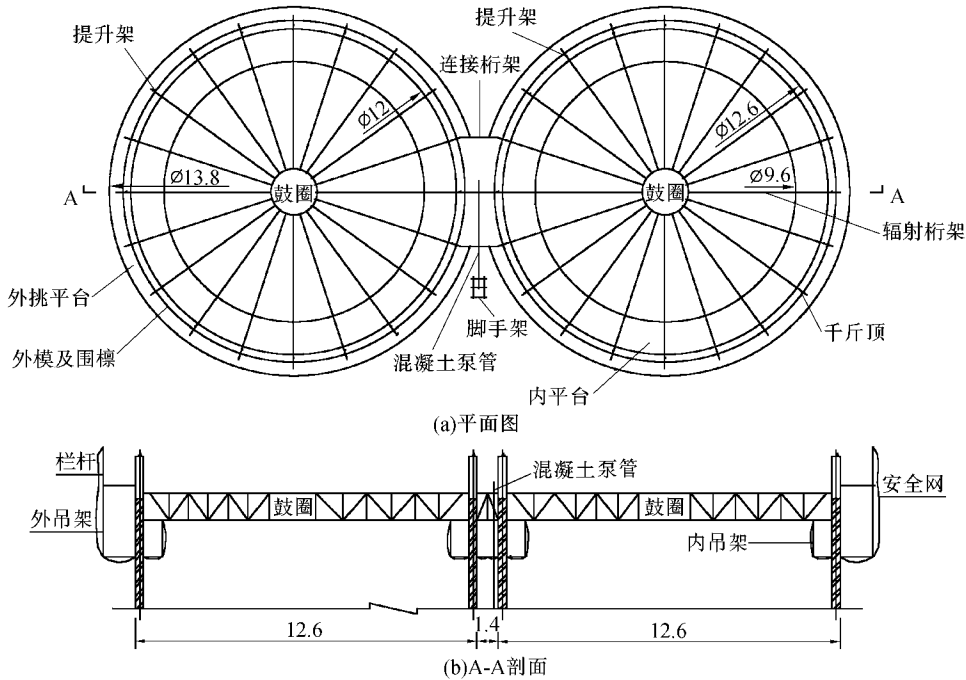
骨料罐混凝土浇筑滑模结构(单位:m)
